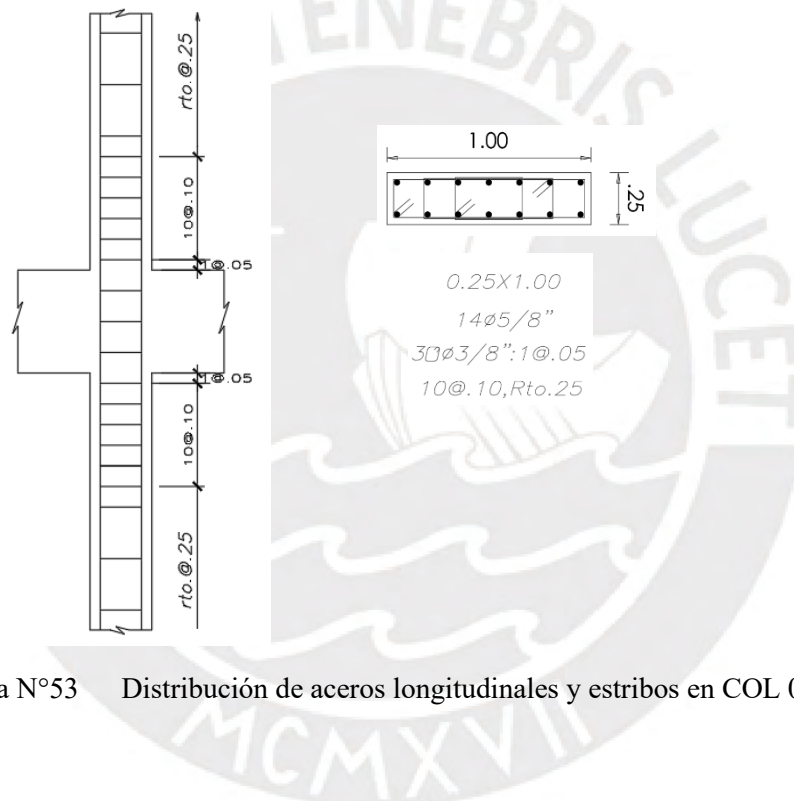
Distribución de aceros longitudinales y estribos en COL 03
